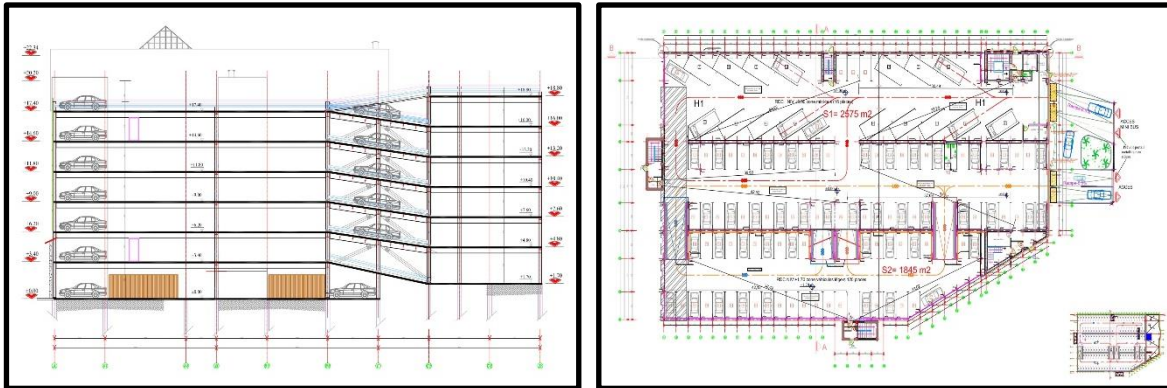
Coupes de l'ouvrage [Autodesk AutoCAD – Bureau d'études]
